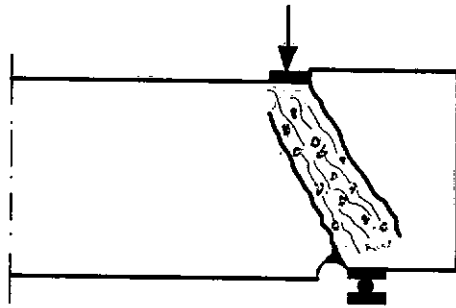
Ruptura por esmagamento da biela de concreto (Strut-like failure)
